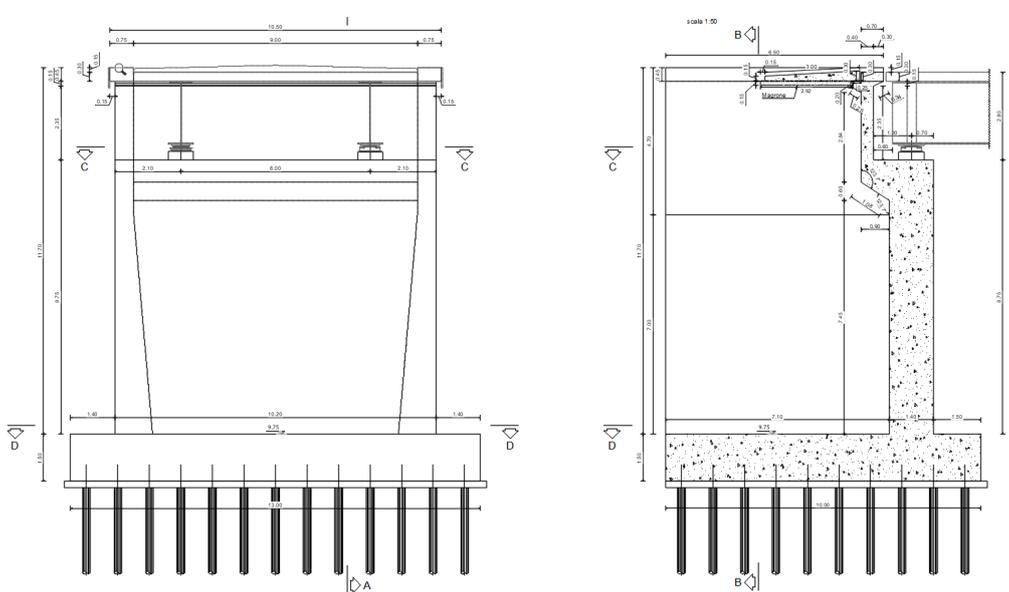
Prospetto e Sezione spalla "SP1" lato Rotatoria 1
